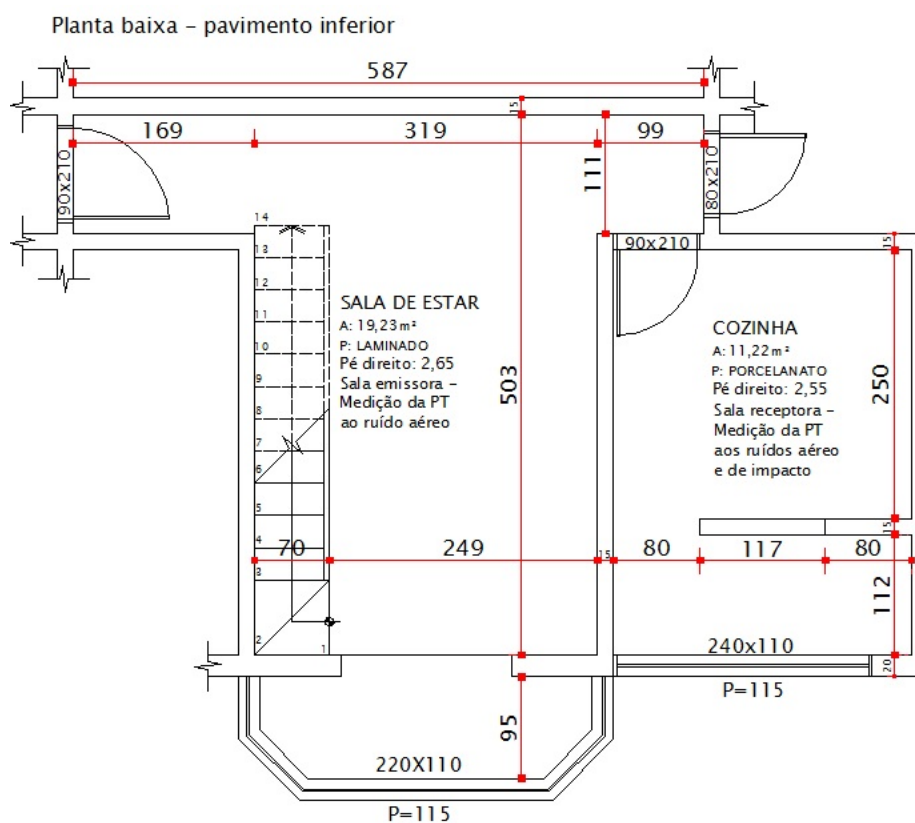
Planta baixa - pavimento inferior - 11-R8-N-BCE
